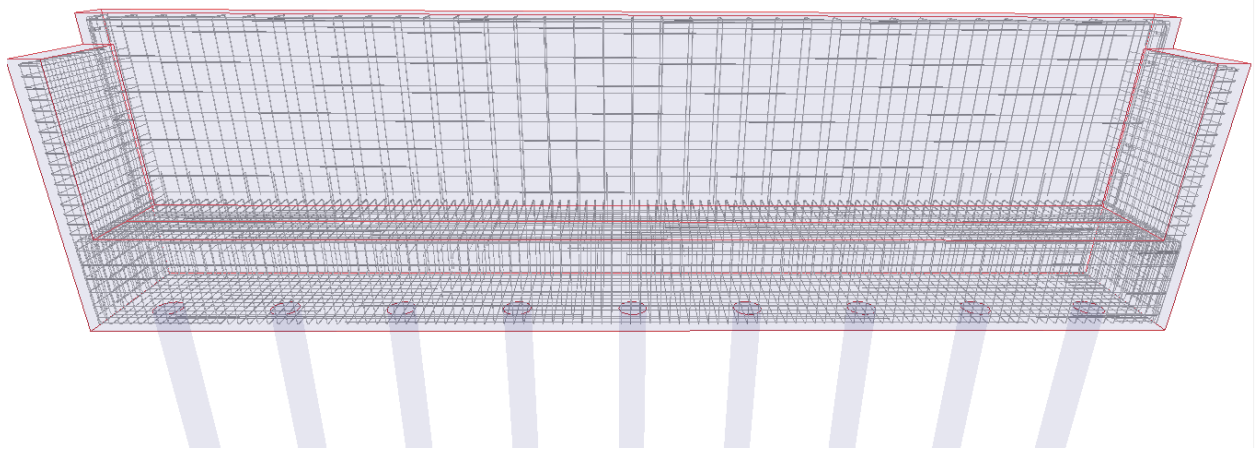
Armadura de hierro en Estribo Flotante (Vista 3D)
